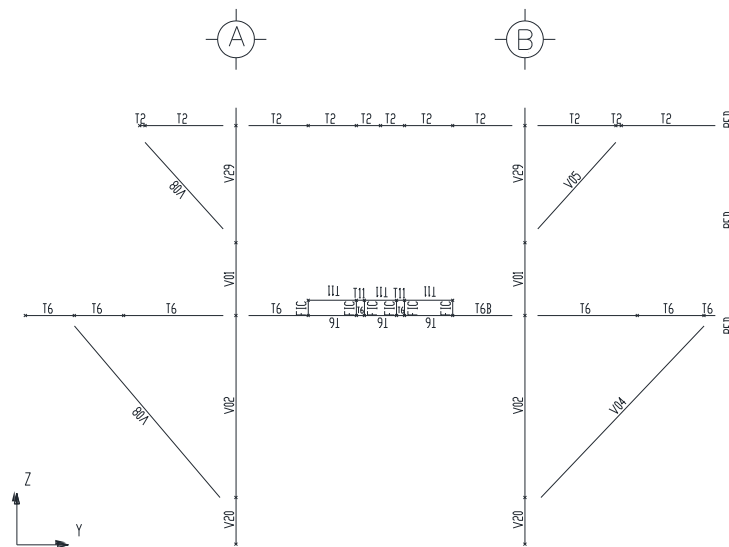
Grupos en marco transversal Eje 2, superestructura
